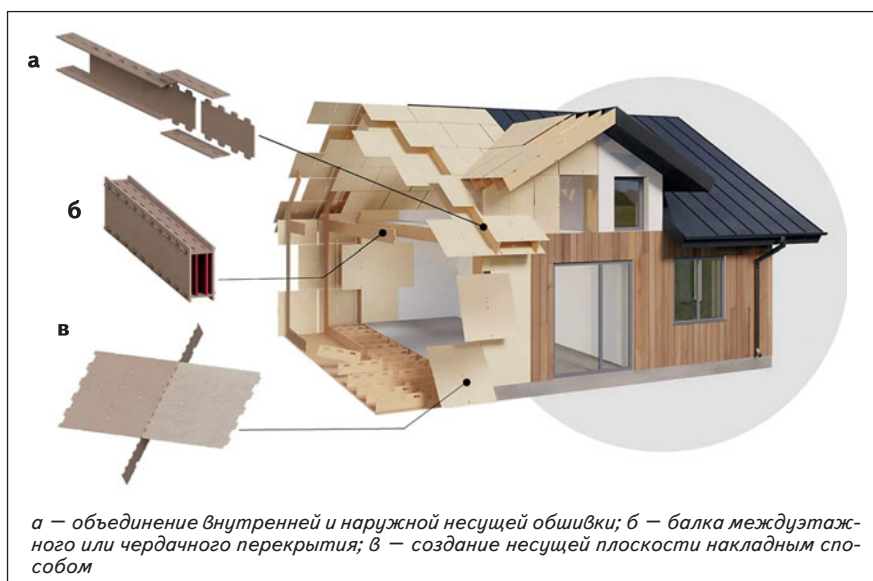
Малоэтажные здания на основе разработанных фанерных элементов
